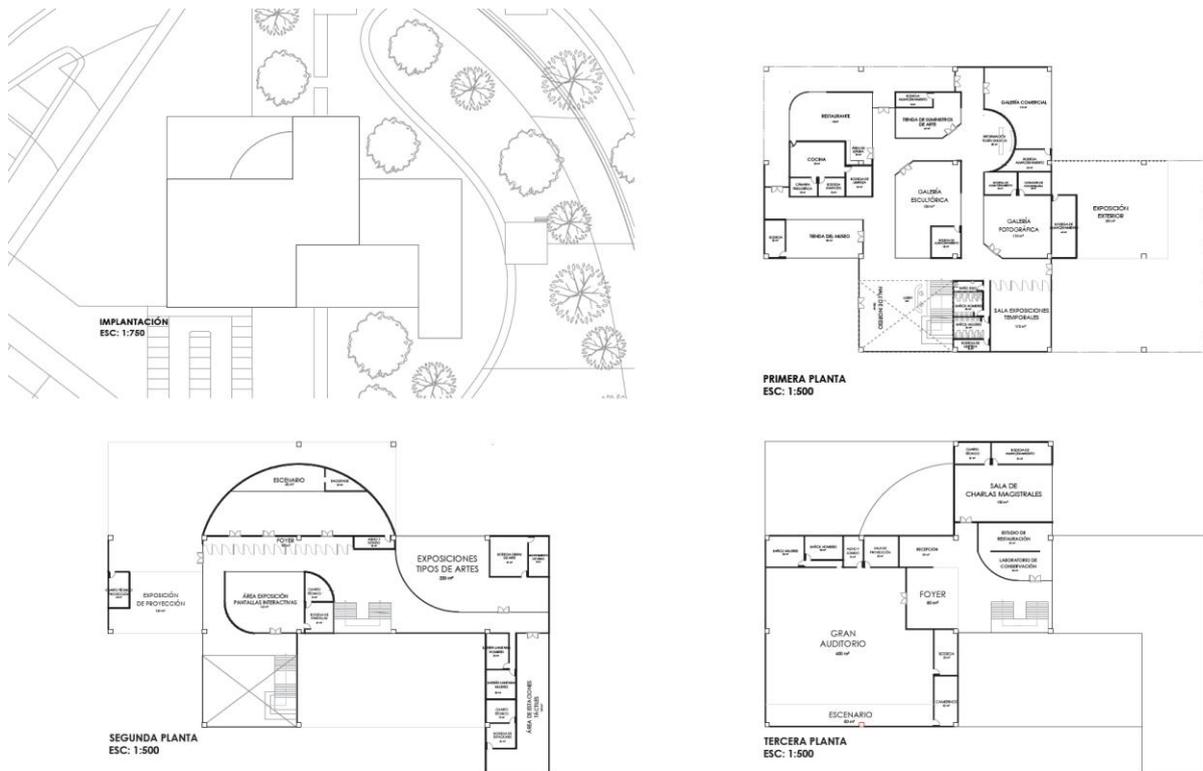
Planimetría primera propuesta arquitectónica. Elaboración propia.
